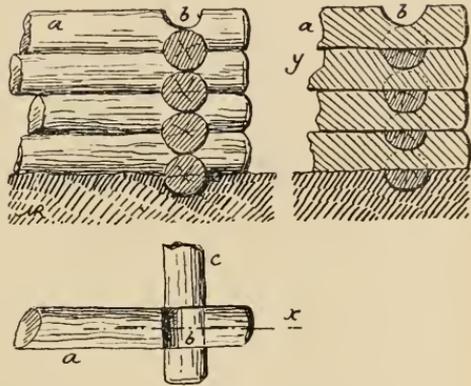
Élévation, coupe et plan d'un angle de construction en troncs d'arbres assemblés.
